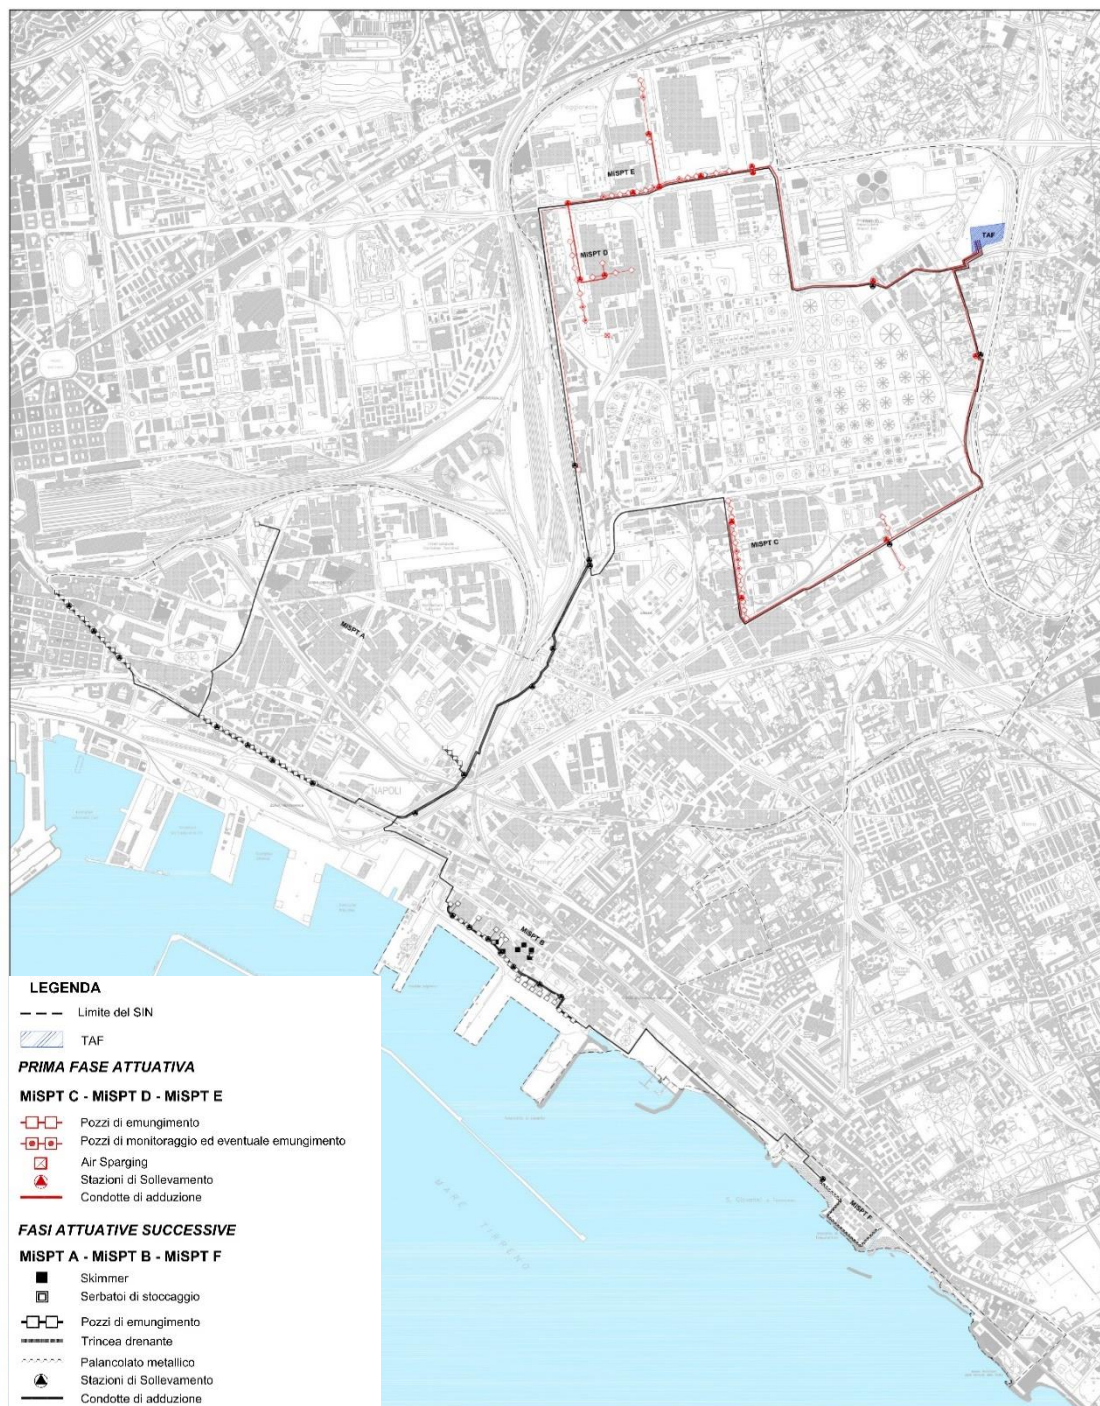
Planimetria degli interventi previsti in progetto nella prima fase e nelle fasi successive.
